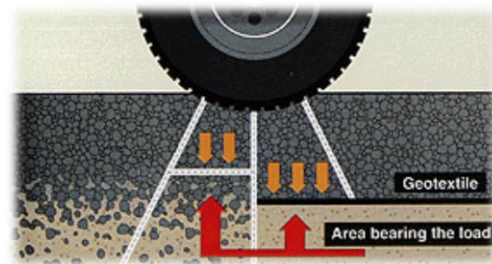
Separación-refuerzo con uso de geotextiles.
